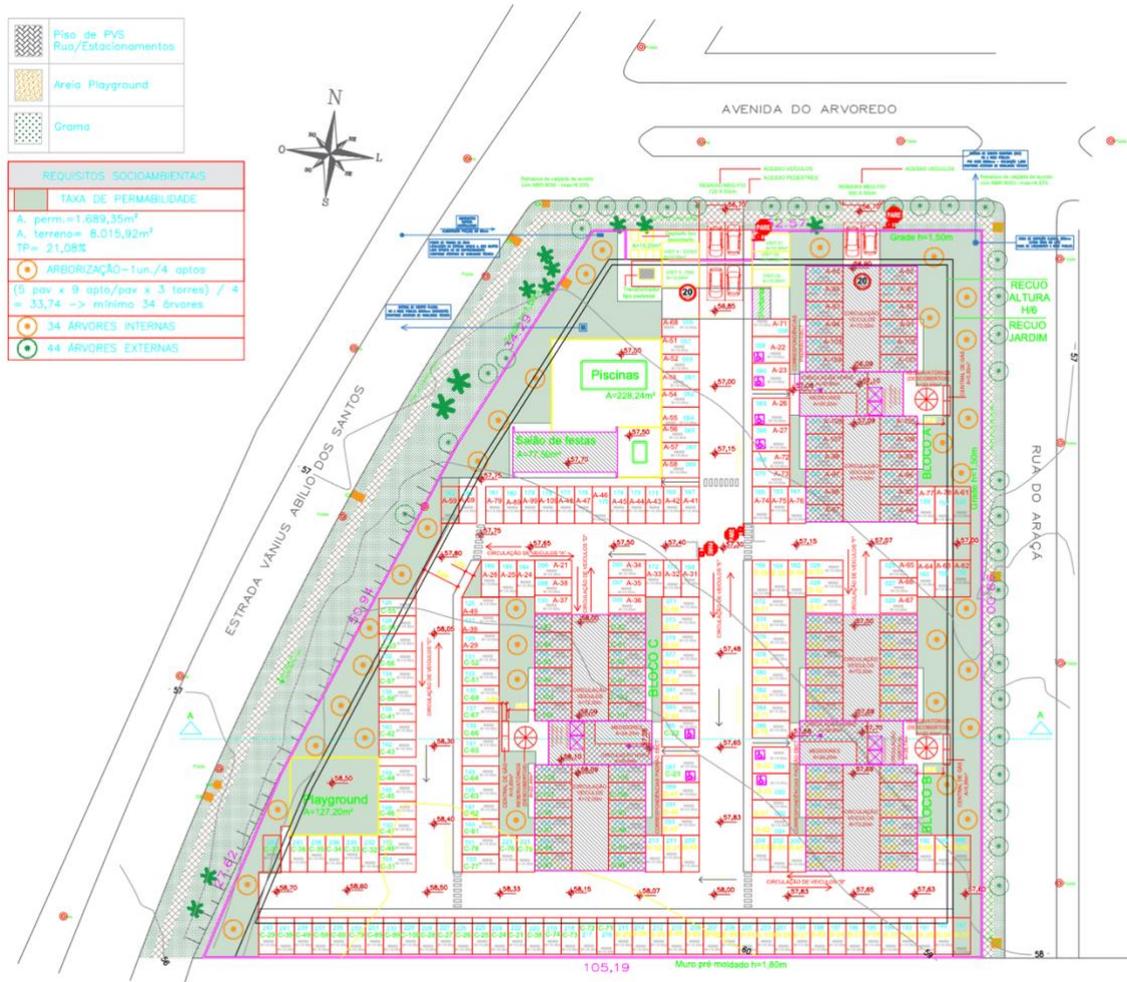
E – Equipamentos da Área do empreendimento
